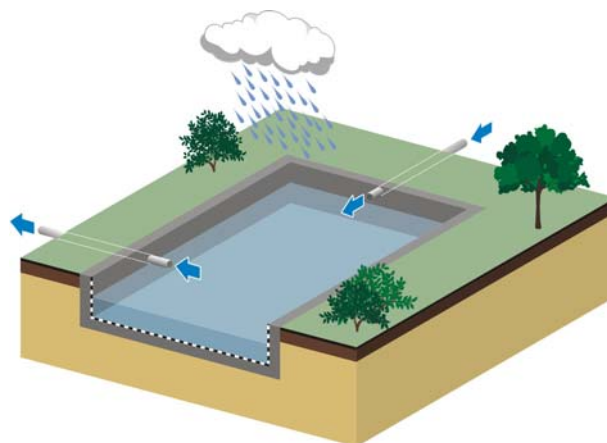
Bassin en eau avec fondations bétonnées. Dans ce cas, l'étanchéité est assurée par la hauteur du marnage. Source : Architecture & Climat.
